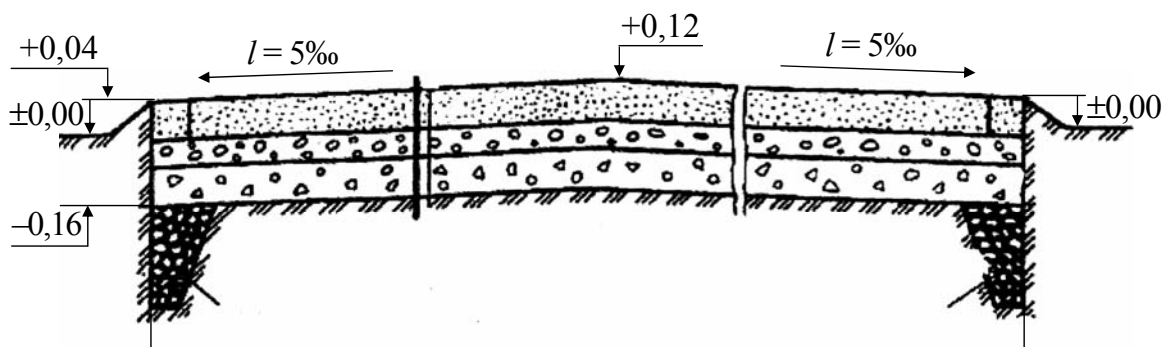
Конструкция простейшей спортивной площадки (разрез) с устройством дренажа и покрытием из специальной смеси из высевок
